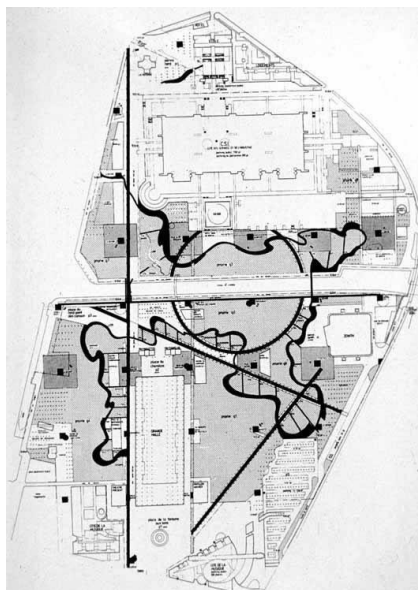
Plano Parc de la Villette. Bernard Tschumi Architects.
